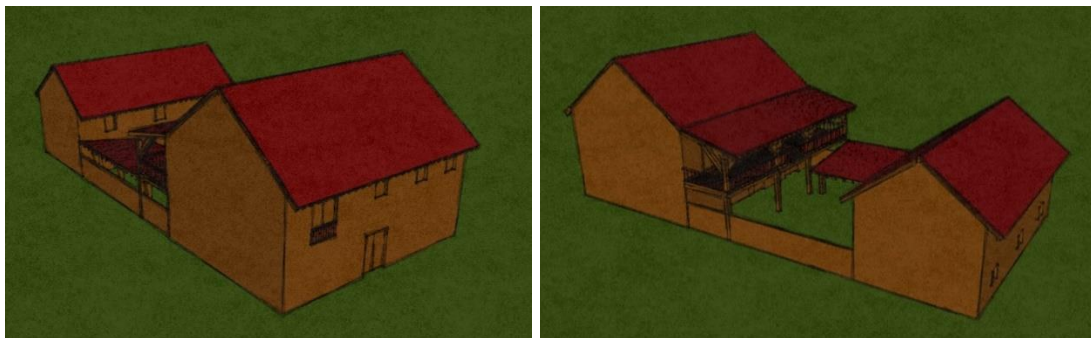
vistas hipotéticas de una vivienda de un oidor de la Audiencia, Casas Reales 1586-1590 (Silvia Arroyo). Ver sección en imagen 4.26, anexo 5 y sección 4.7.
